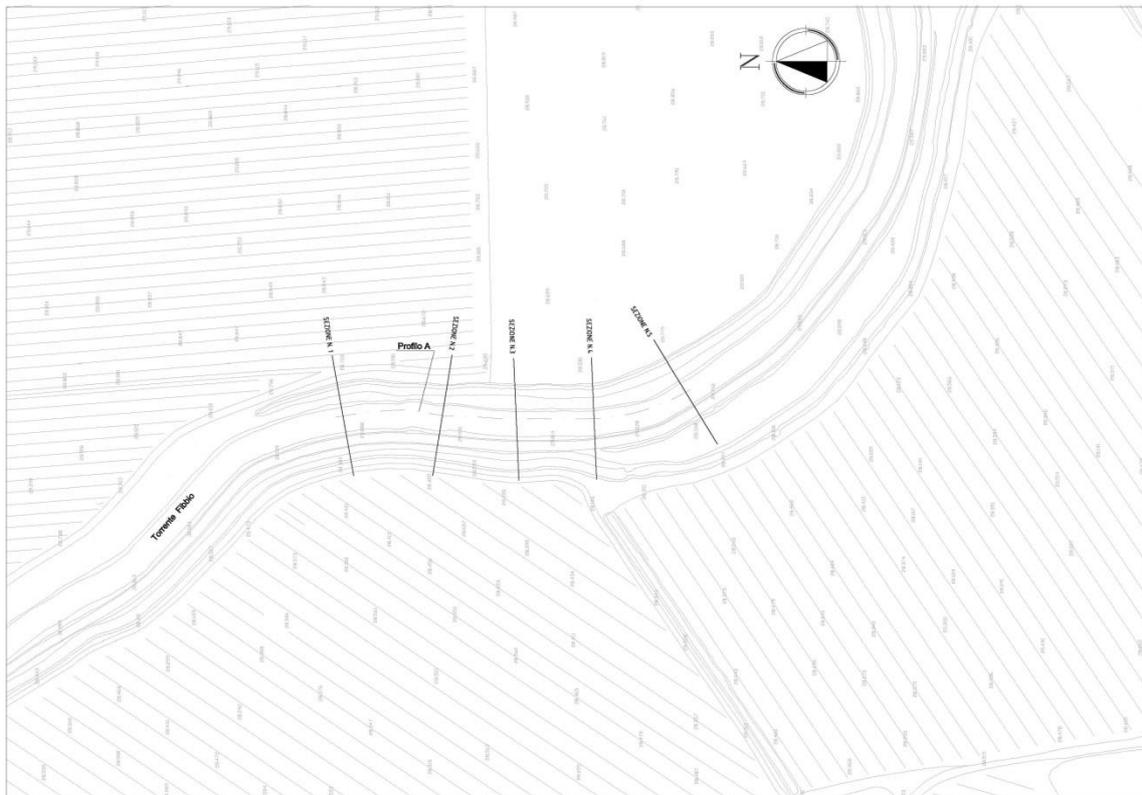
Torrente Fibbio - Planimetria stato di fatto.
